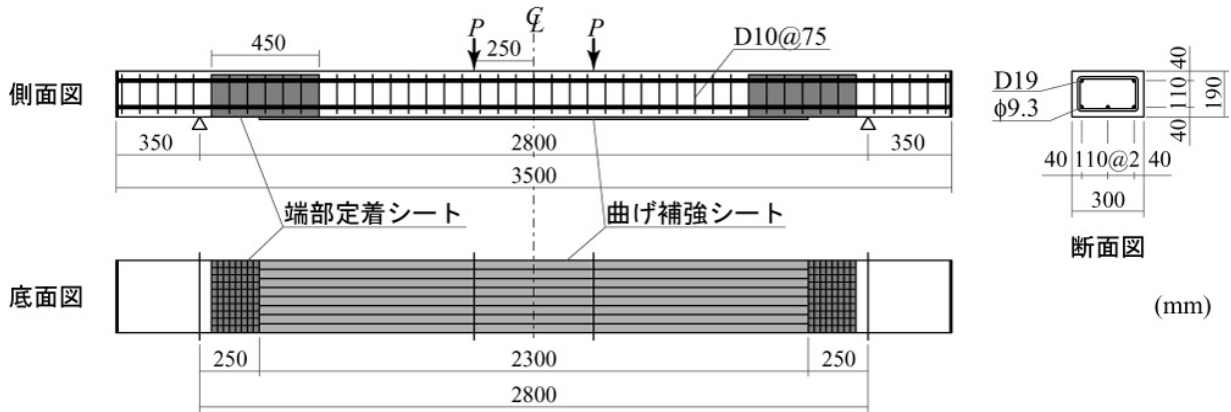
試験体の形状寸法および配筋状況(-S30 試験体)
